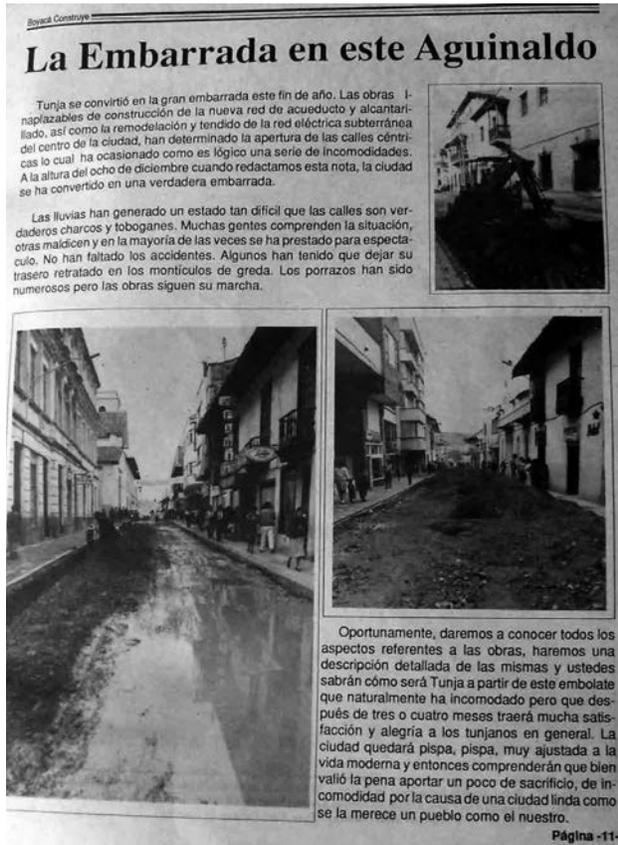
Arreglos del alcantarillado del barrio El Consuelo
